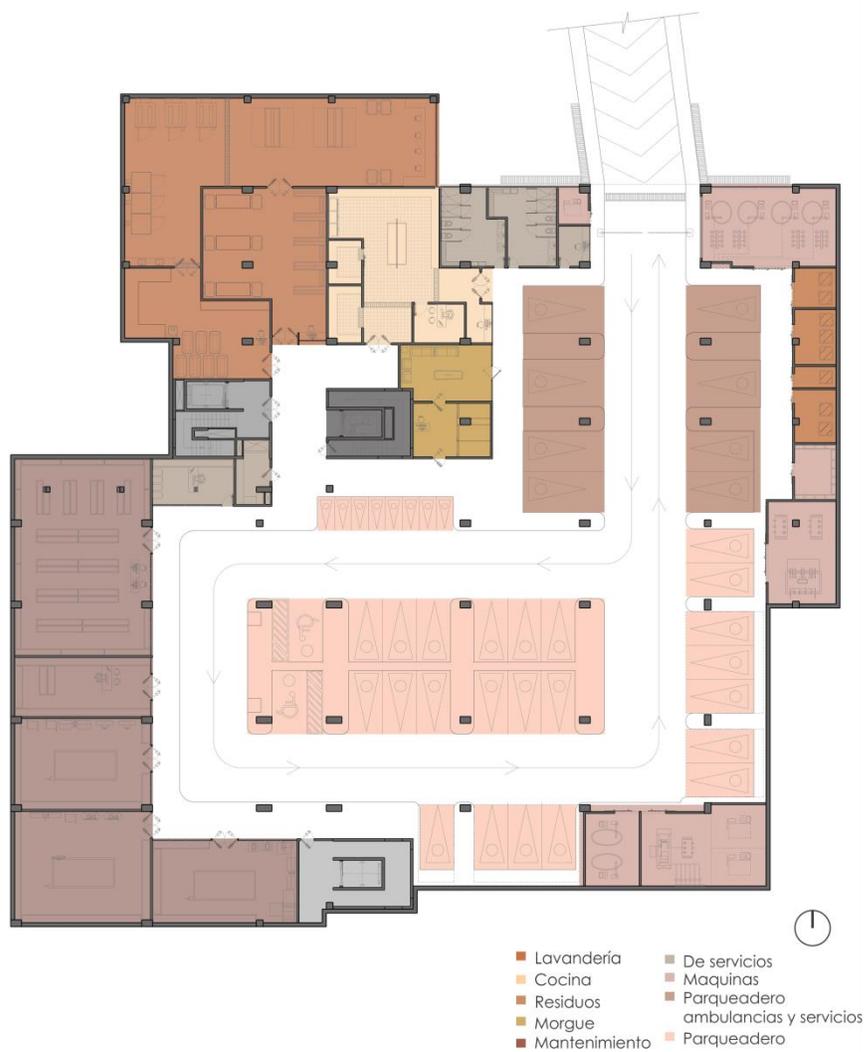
Planta arquitectónica por zonificación, nivel sótano.
